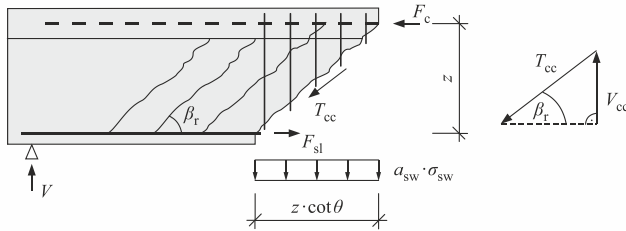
Fachwerkmodell mit Rissreibung – Kräfte am Querkraftriss nach [Rei-2001]
